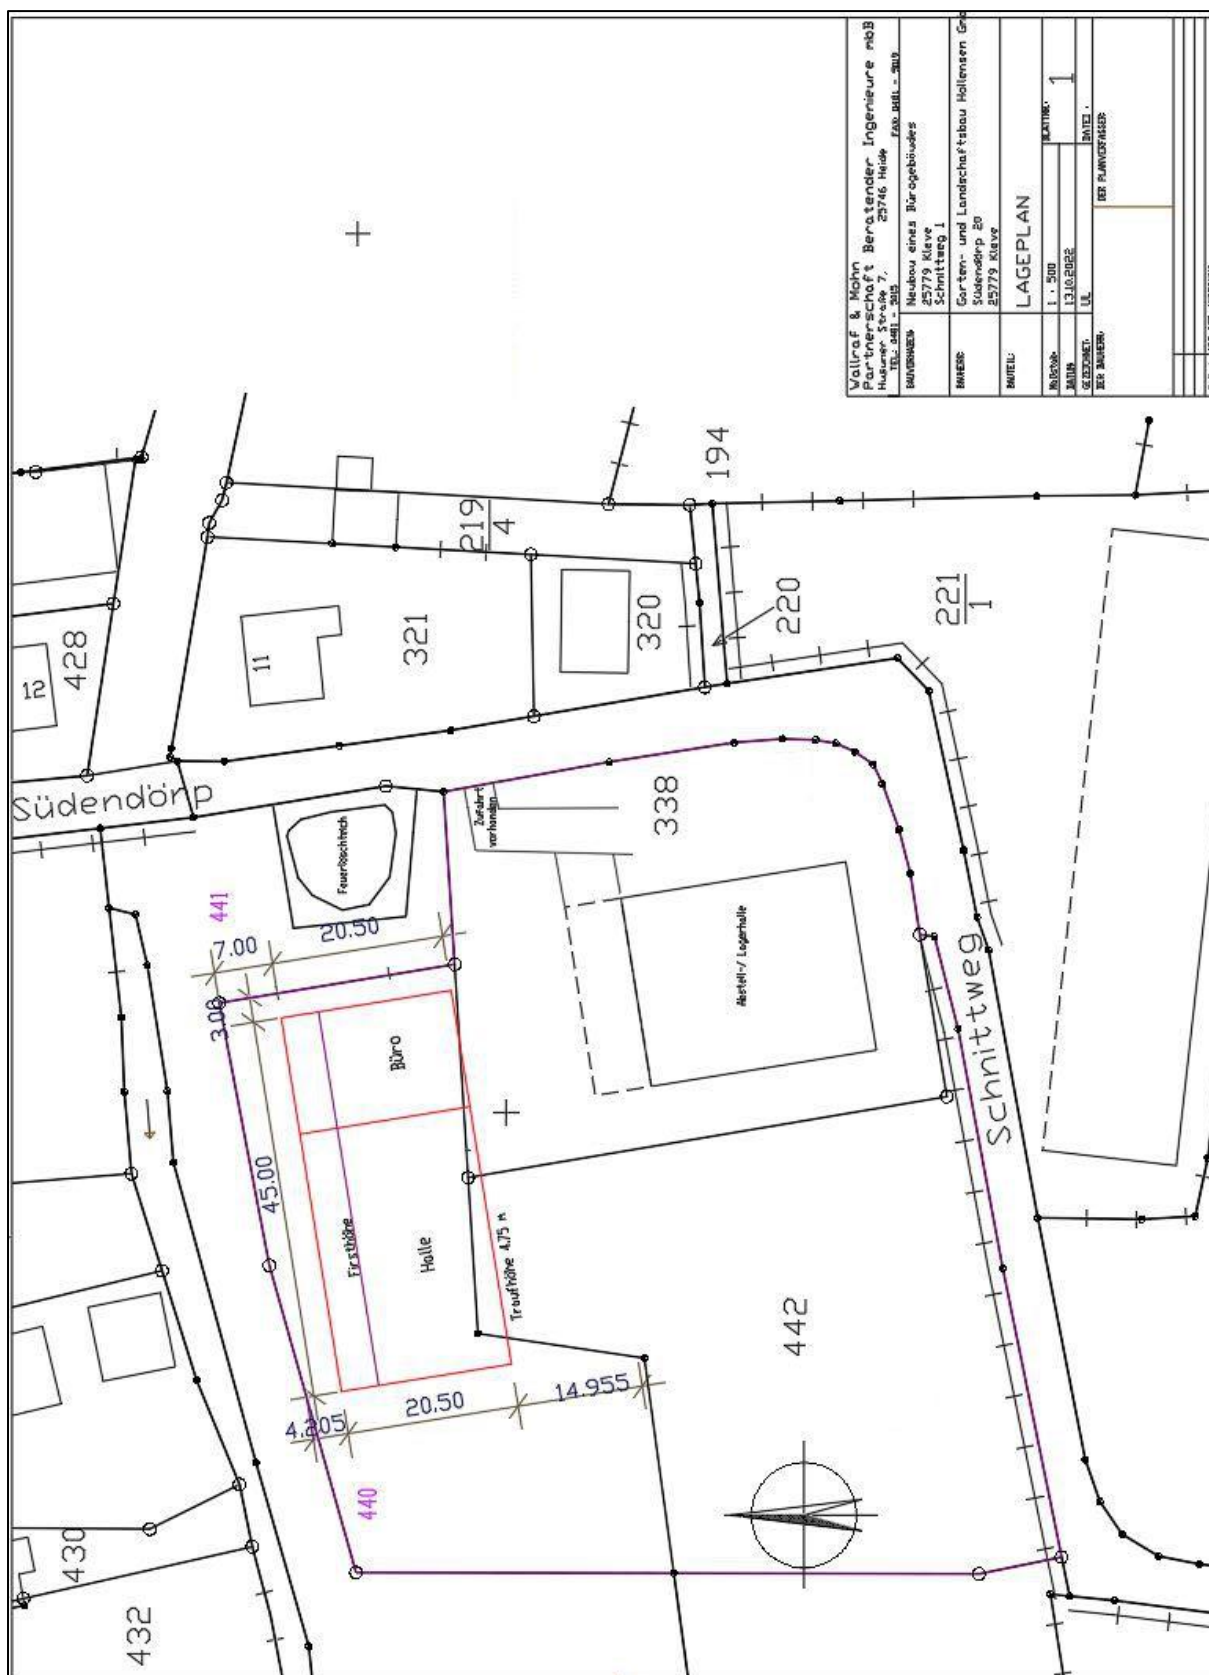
Lageplan Bestand/Neuerrichtung Lagerhalle Kleve; Stand: 13.10.2022
